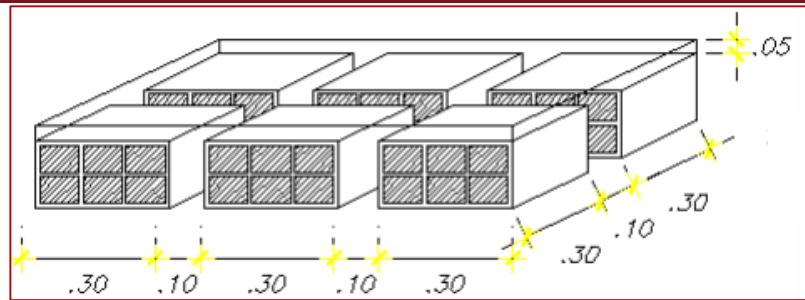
Esquema de Losa Aligerada Bidireccional.
